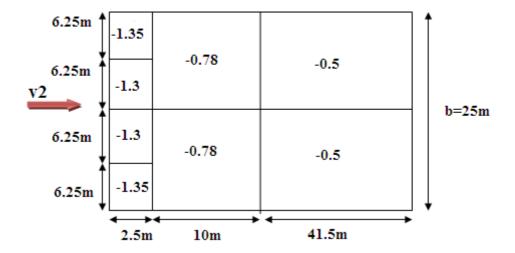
Valeurs de Cpe pour la toiture, vent sur pignon
